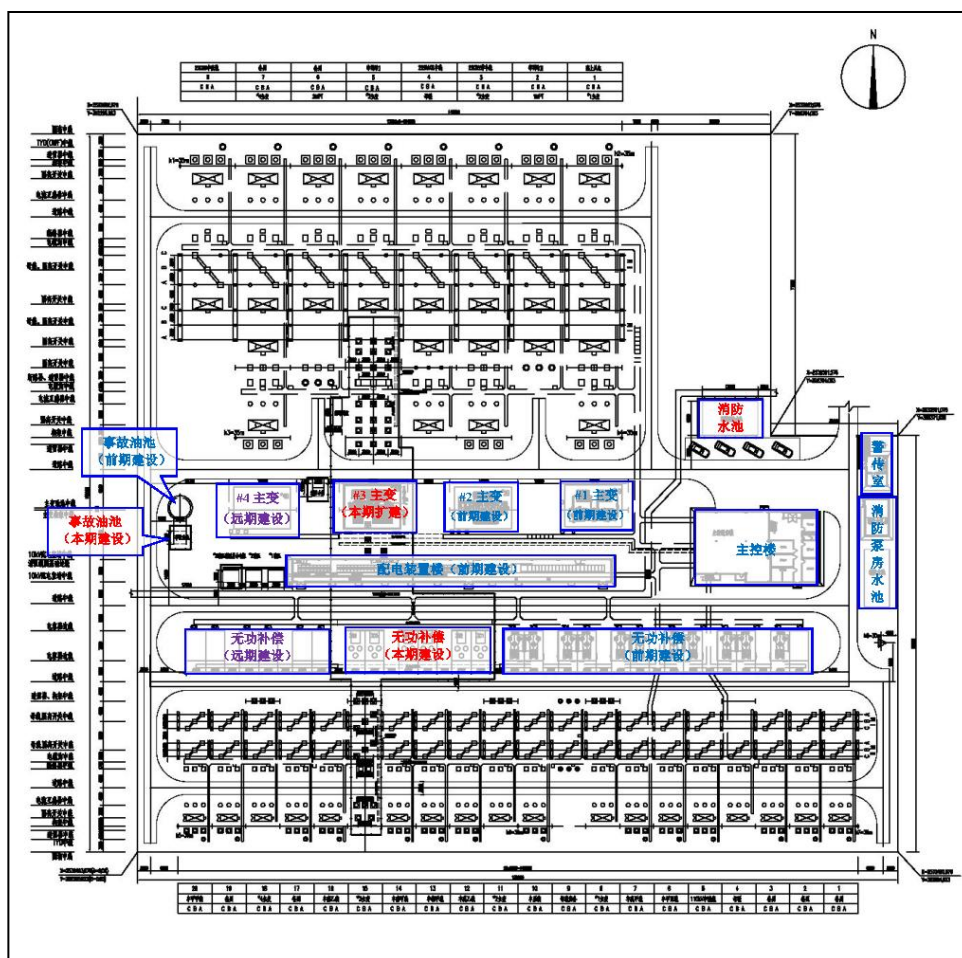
220kV 丰港站总平面布置示意图（扩建后）
